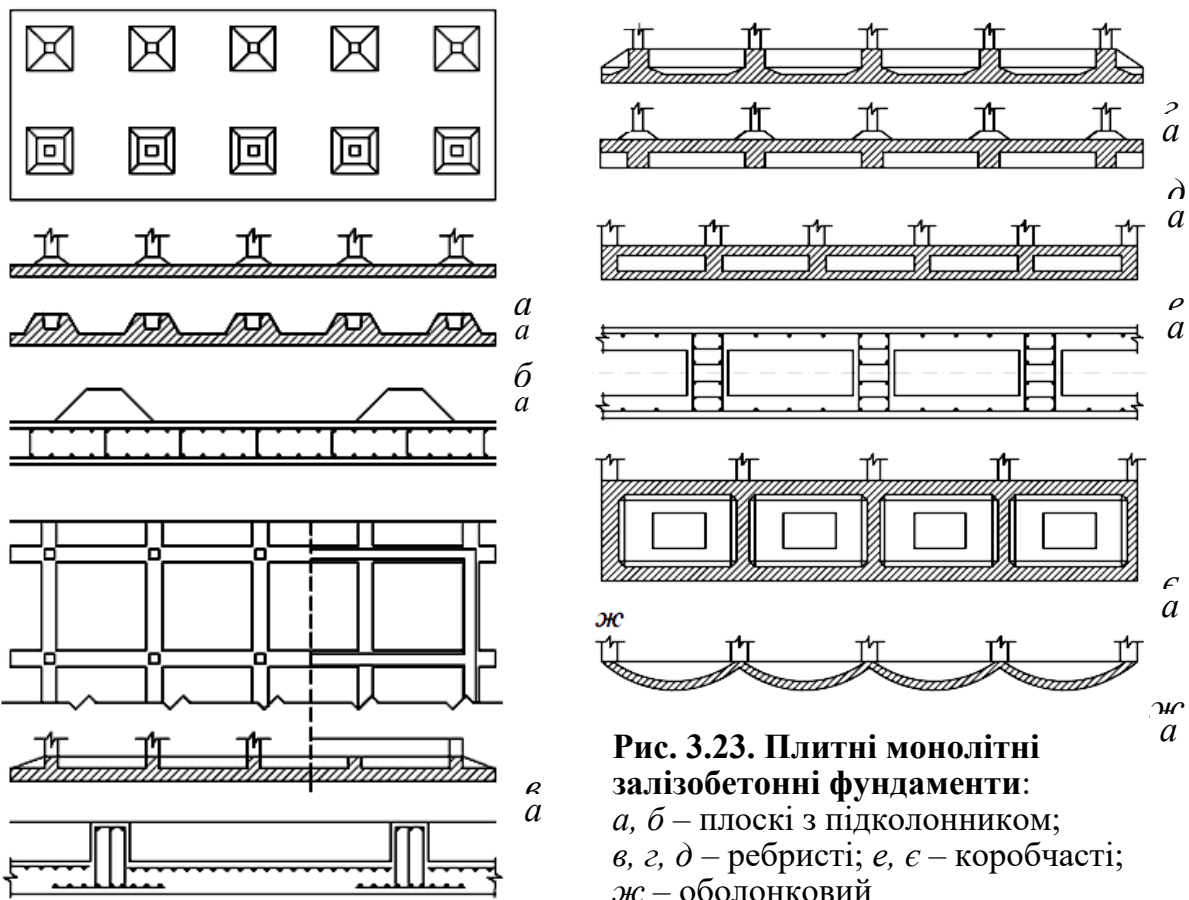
Плитні монолітні залізобетонні фундаменти:
